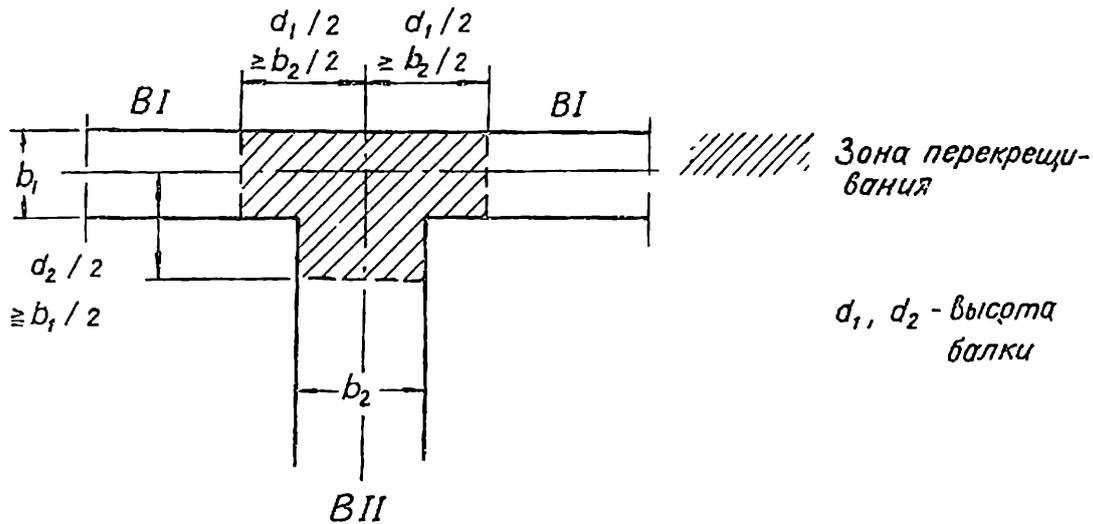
4. В указанной зоне можно располагать арматурную подвеску
